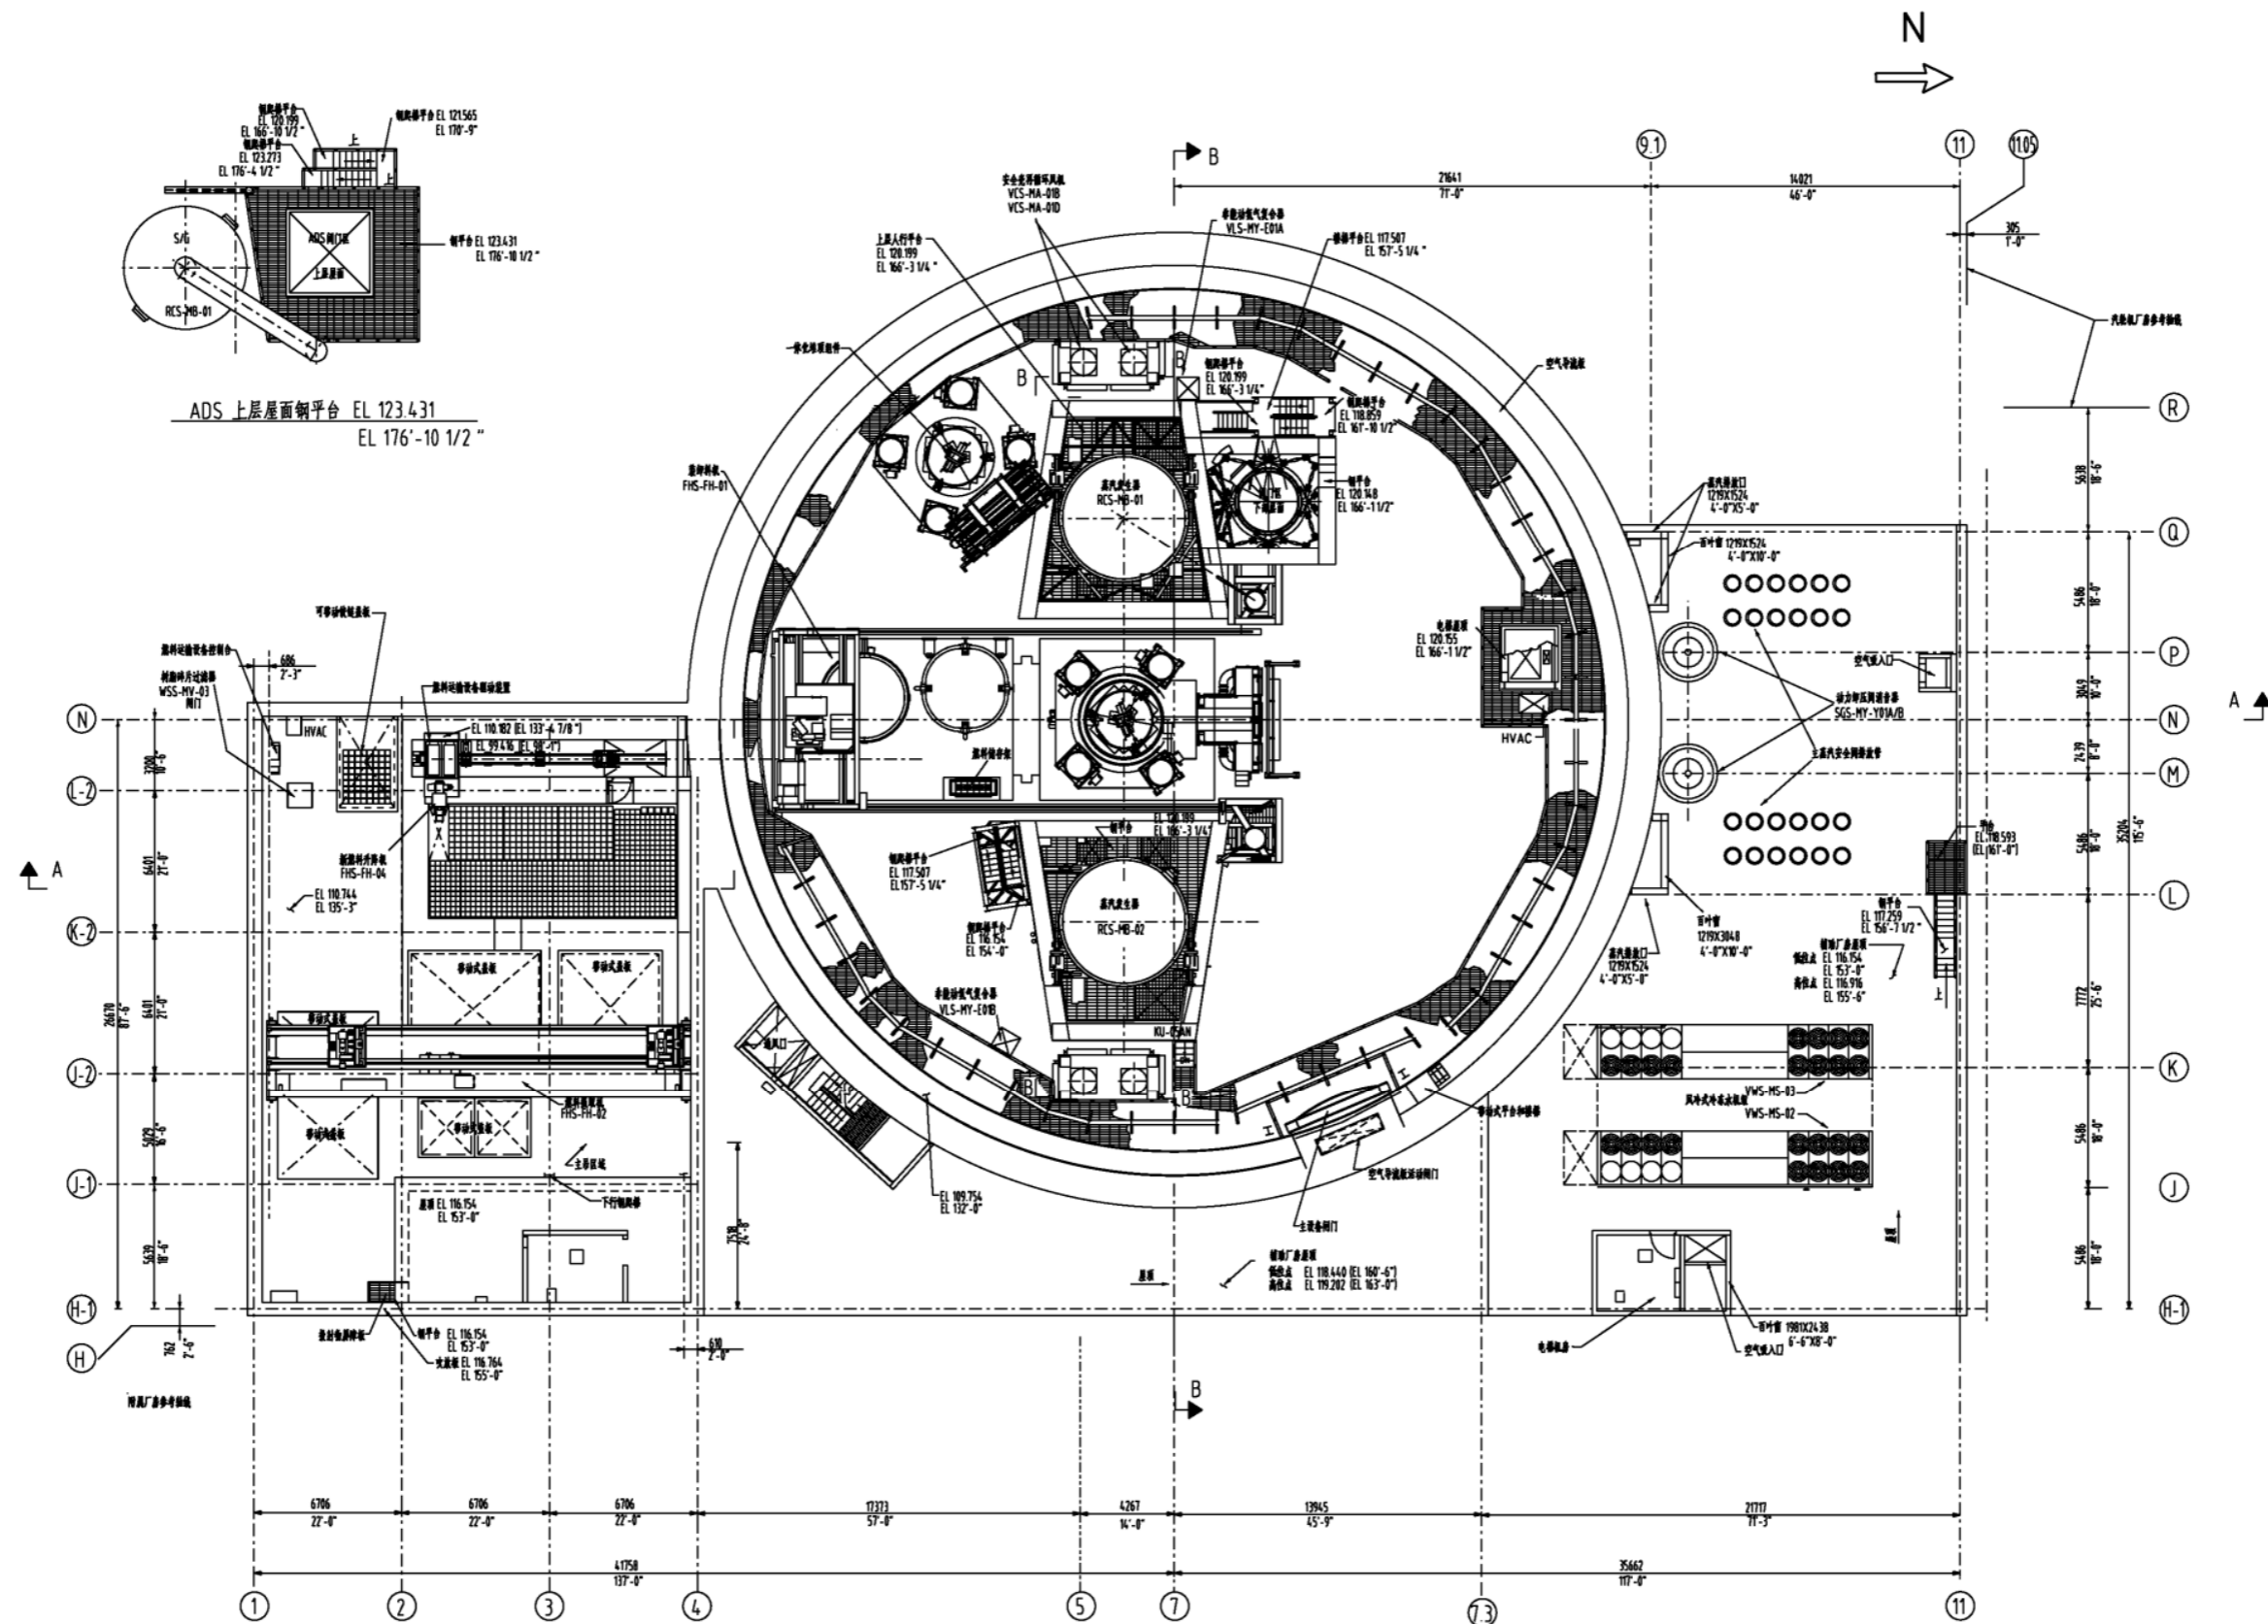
核岛厂房布置示意图 116.154m 及 118.440m
